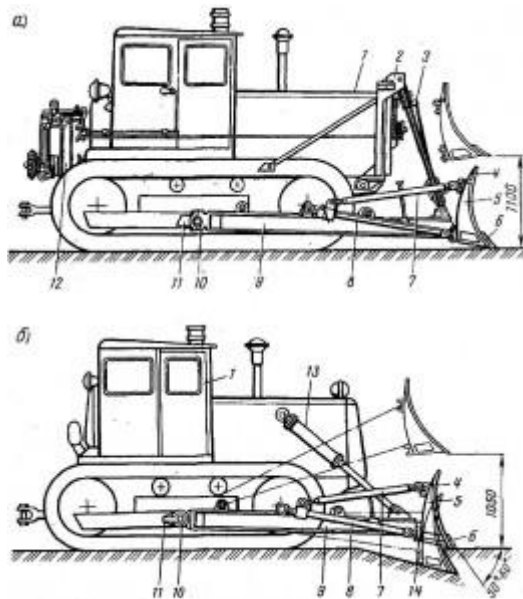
Бульдозеры: а — с механическим приводом; б — с гидравлическим приводом; 1 — базовый трактор; 2 — передняя стойка; 3 — полиспагат канатно-блочной системы; 4 — козырек от вала; 5 — отвал; 6 — ножи; 7 — подкосы; 8 — толкатели; 9 — универсальная толкающая рама; 10 — опорные шарниры крепления толкающей рамы к раме трактора; 11 — опоры; 12 — приводная однобарабанная лебёдка; 13 — гидроцилиндры управления отвалом; 14 — шаровое соединение отвала с универсальной толкающей рамой.
